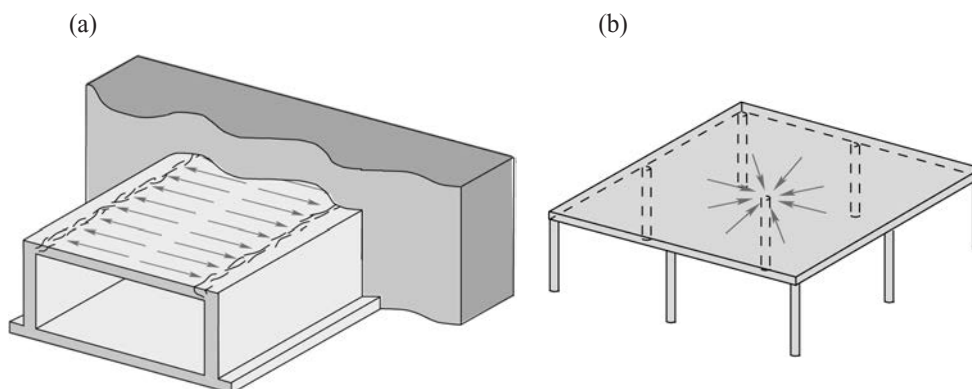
Transmisión de esfuerzos cortantes en losas de hormigón armado: (a) losa superior de un falso túnel; y (b) losa apoyada sobre columnas.
